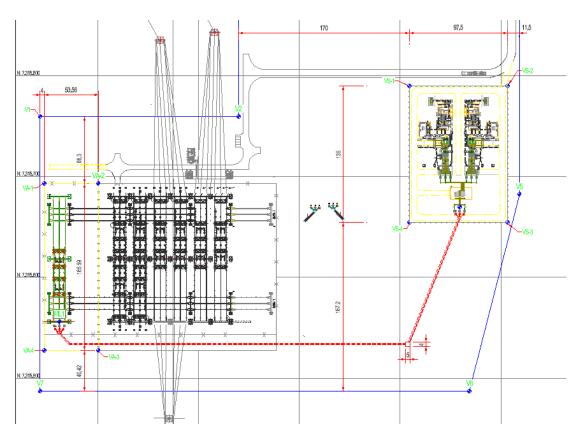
Diagrama de planta de la subestación Monte Mina y de los equipos CCSS (Vista superior).
